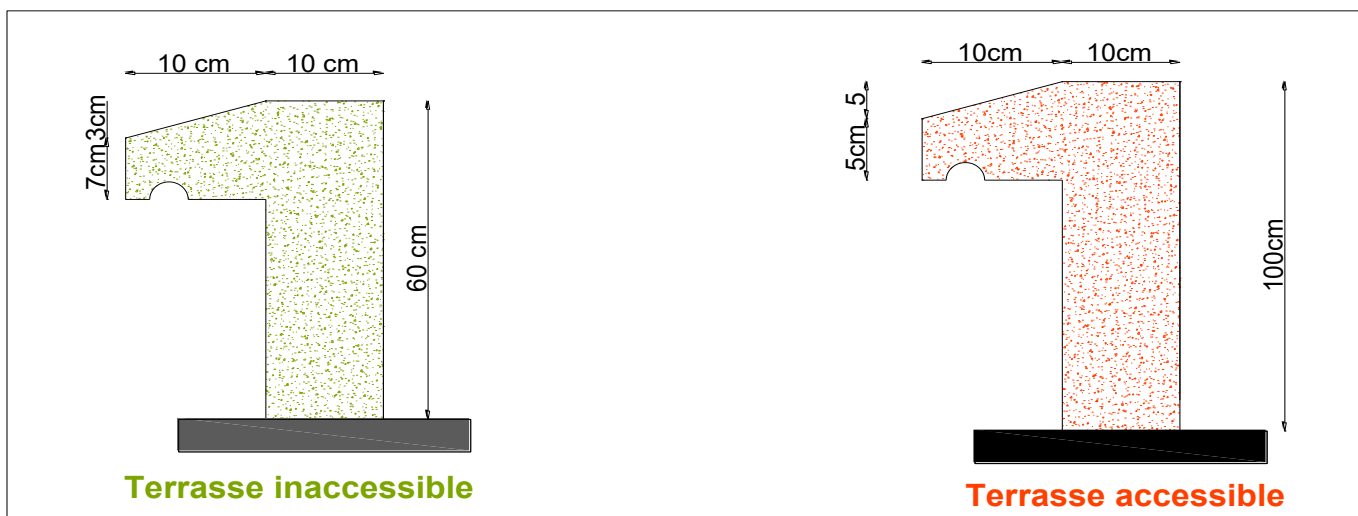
L'acrotère de la terrasse accessible et inaccessible.
